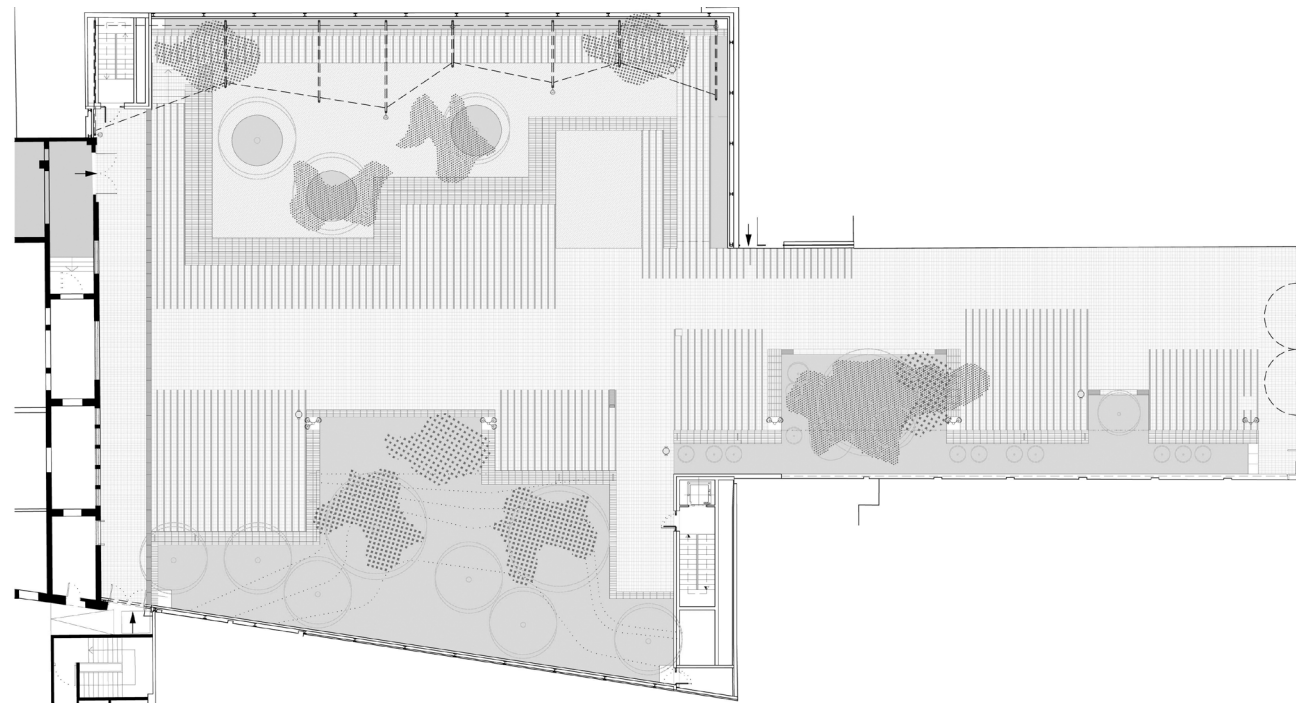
Planta arquitectónica. Jardín de manzana Fuente: Biental Internacional de paisatge Barcelona
